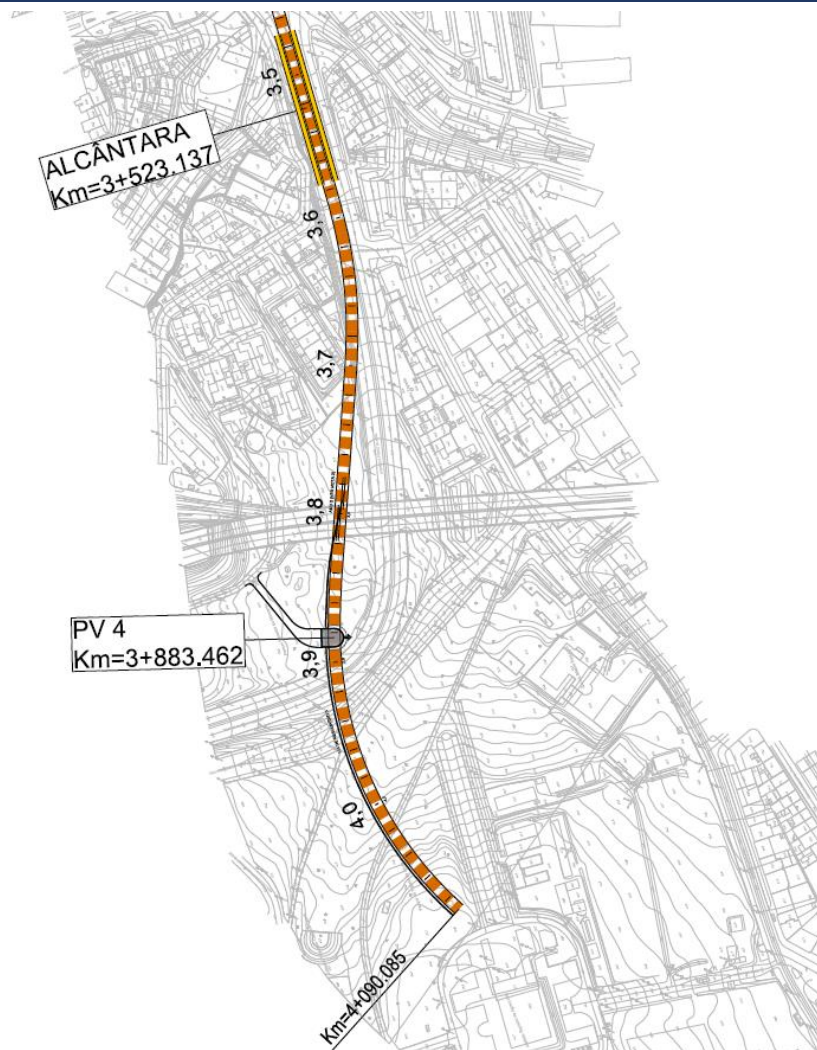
Traçado em planta - troço Estação Alcântara - Término
